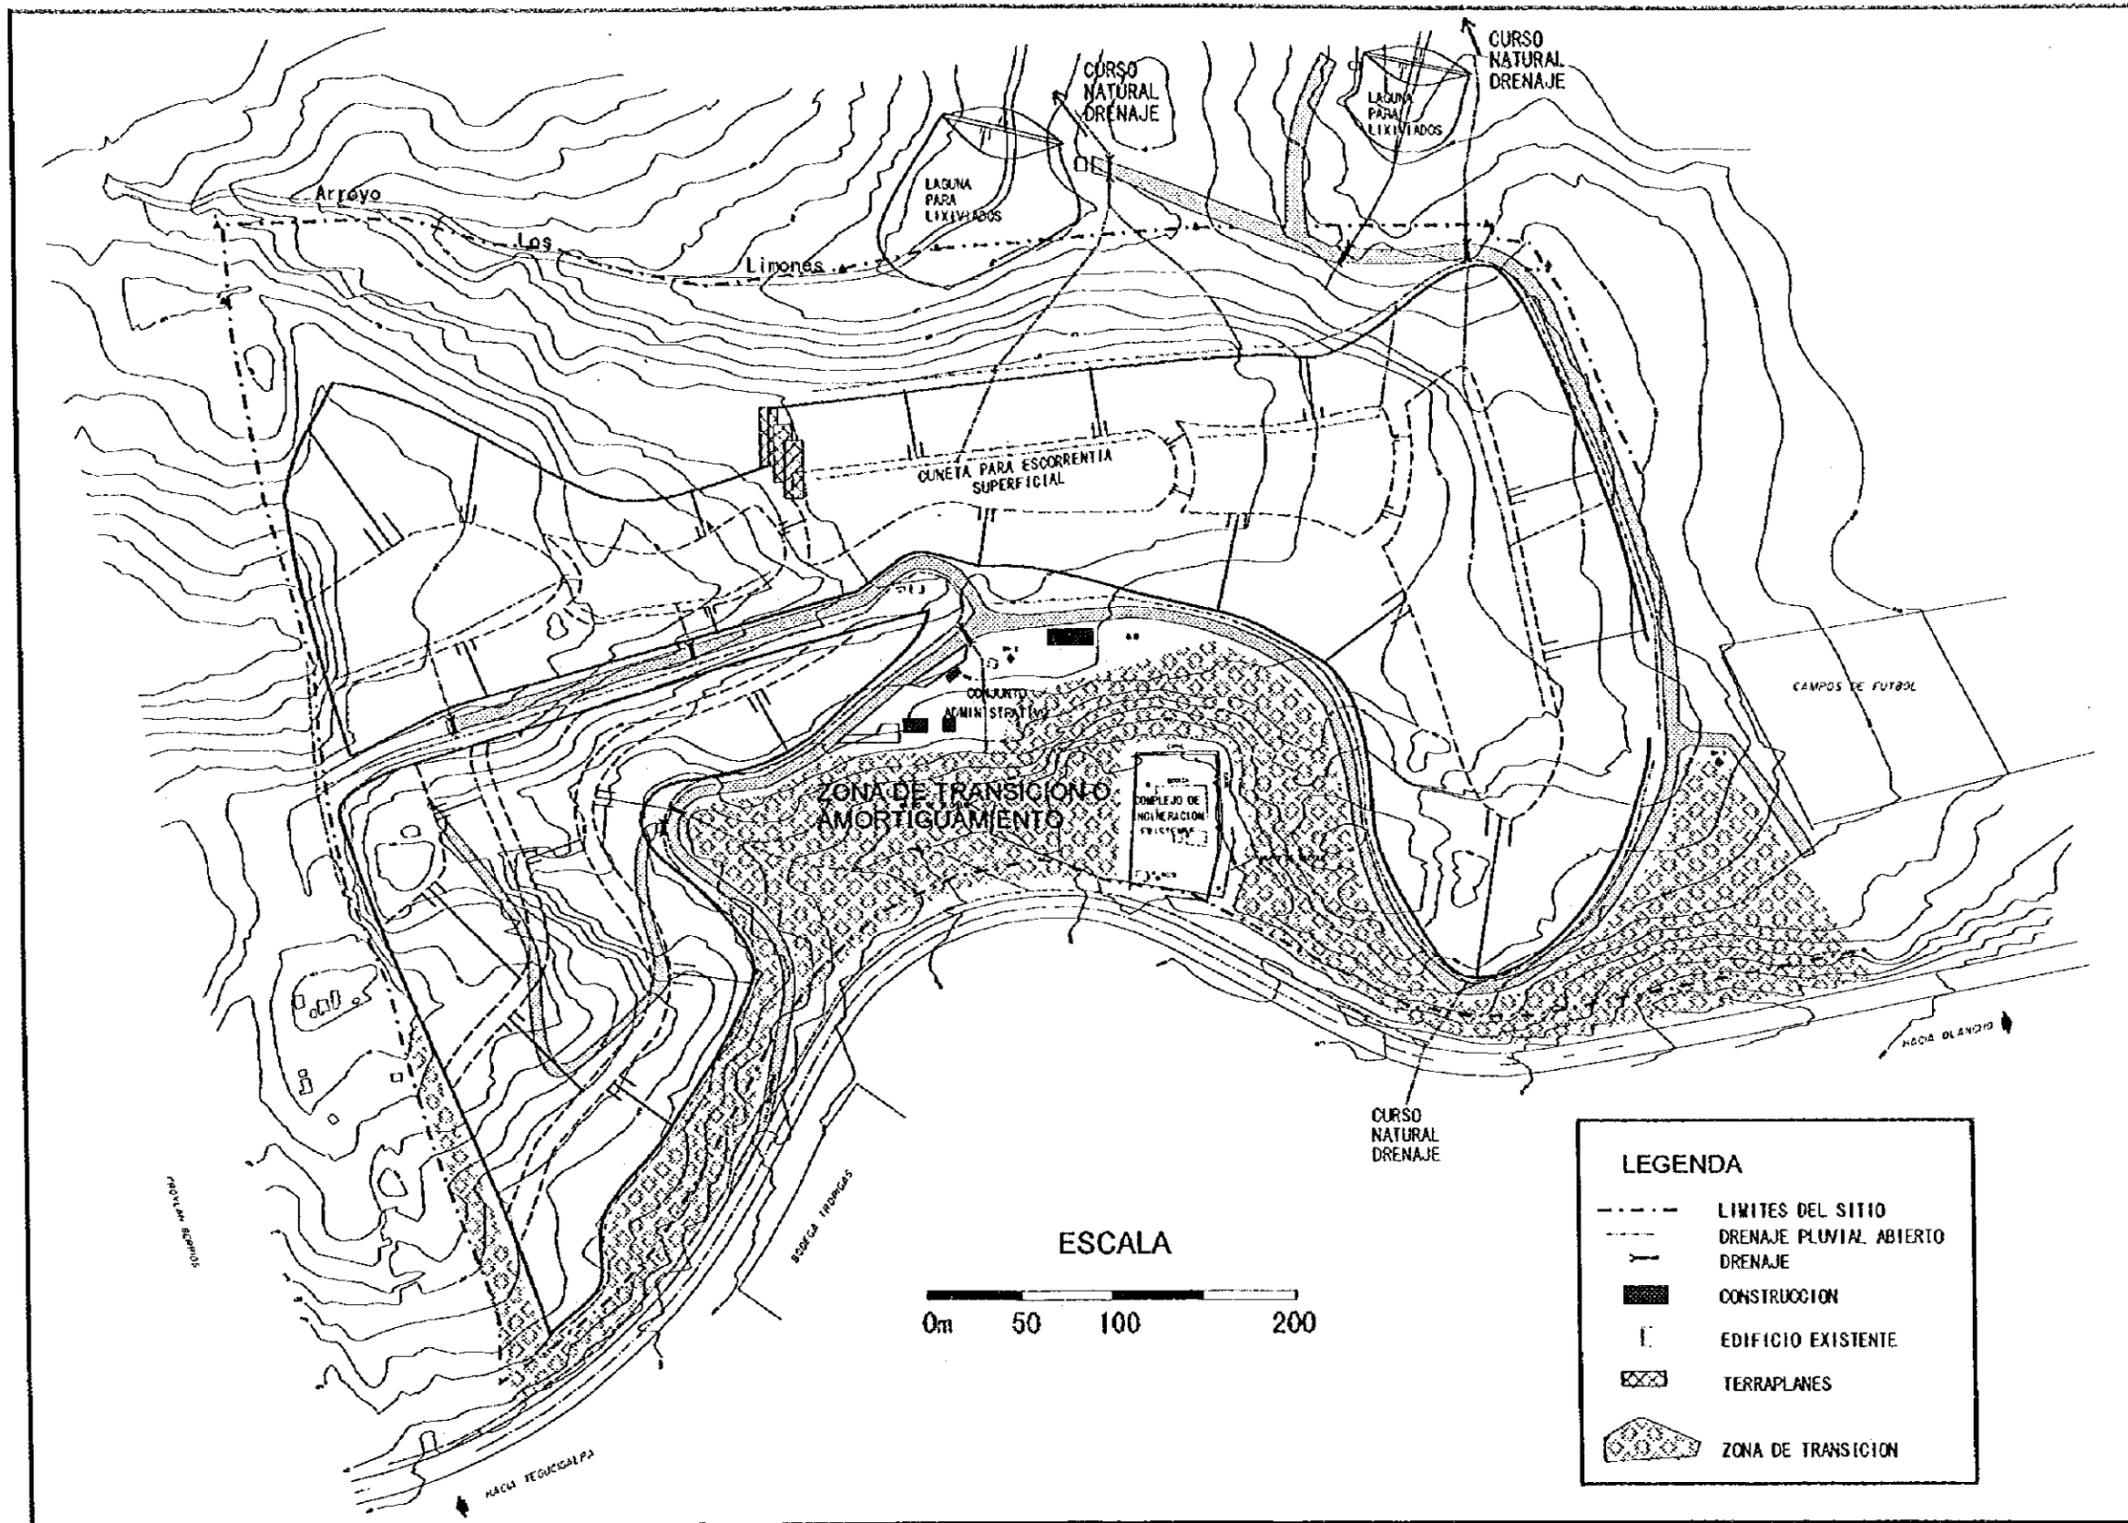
Plano Esquemático del Sitio de Disposición Mejorado
